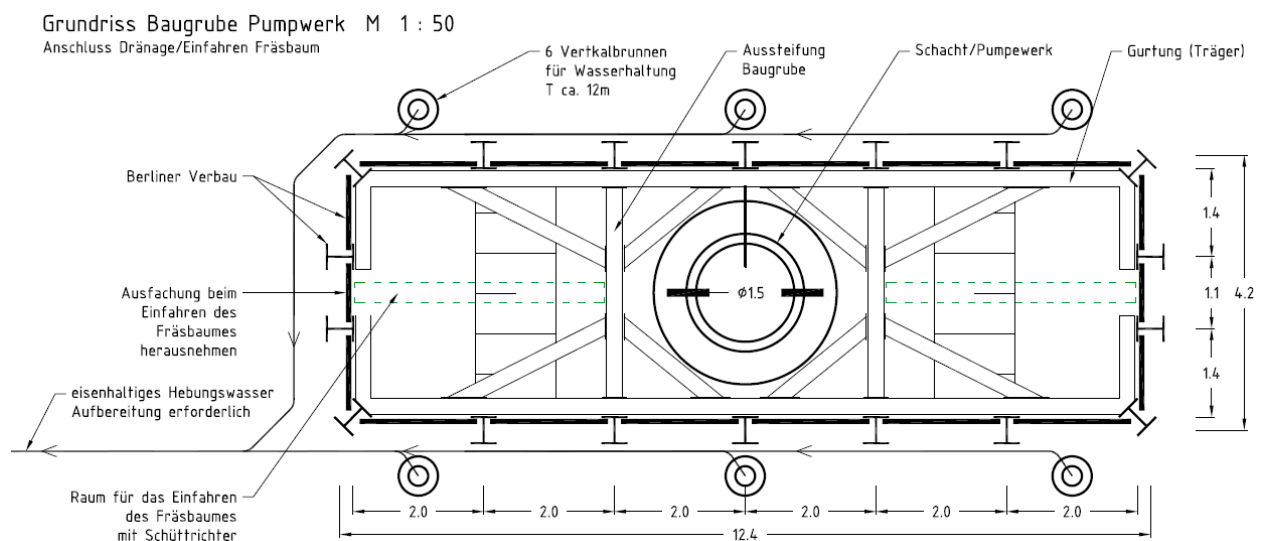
Grundriss Baugrube Pumpwerk, Einfahren des Fräsbaumes
